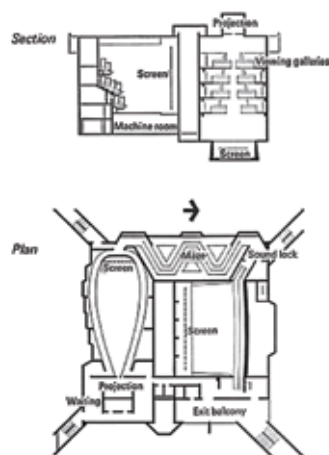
Planta y sección del Pabellón del Laberinto, 1967.
